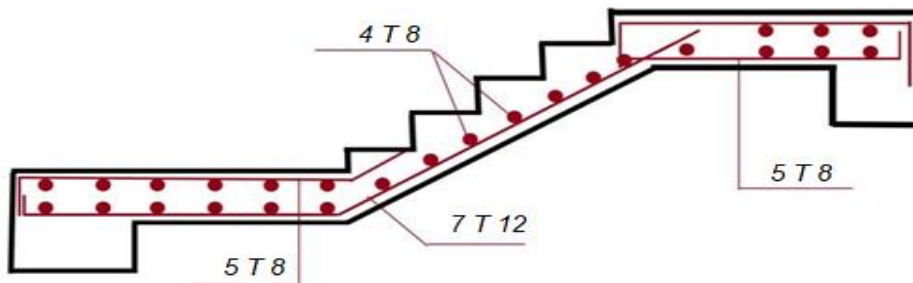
Schéma du ferrailage de la volée 1 de l'escalier.
